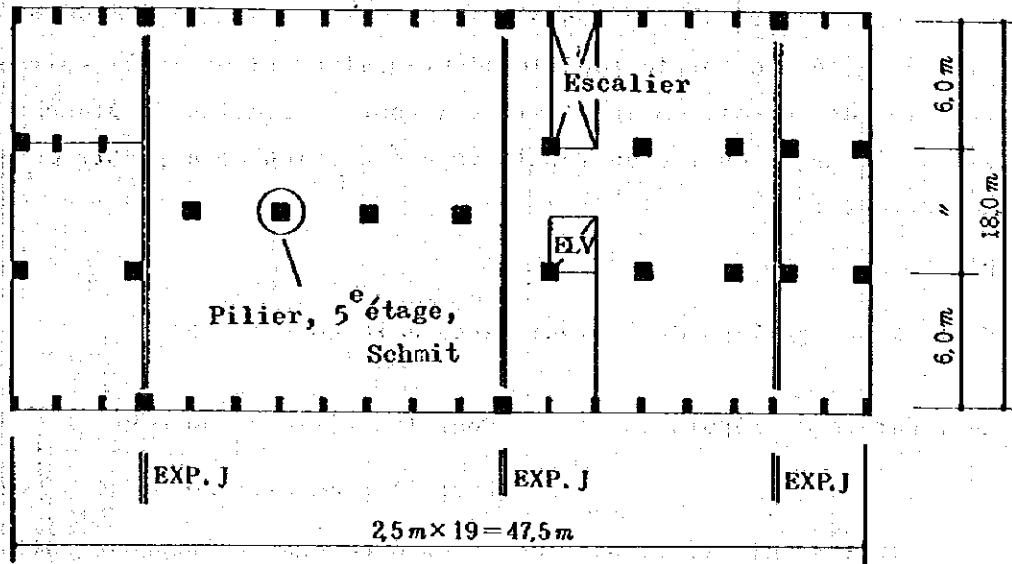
Plans et endroits de recherches de l'usine de meunerie SEMPAC
